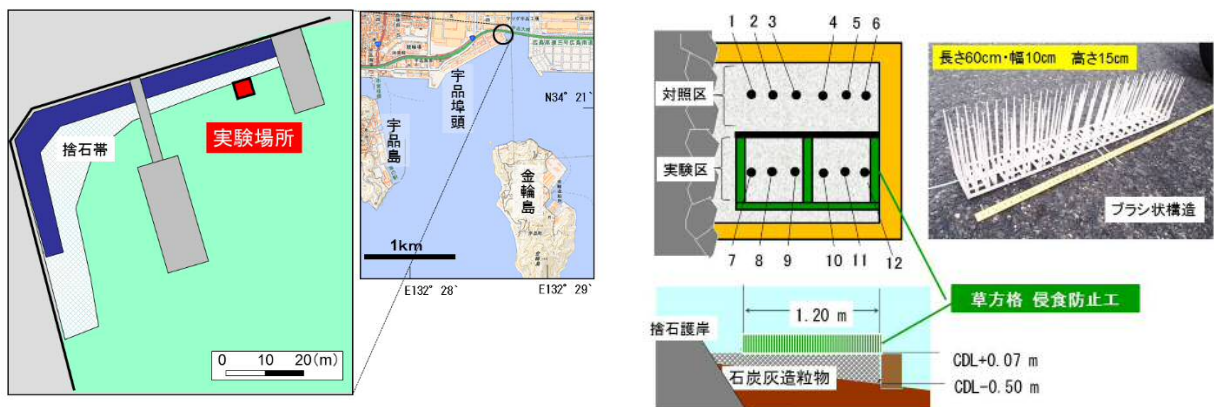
現地実証実験の平面配置図、断面図及び防止工仕様<sup>19)</sup>
